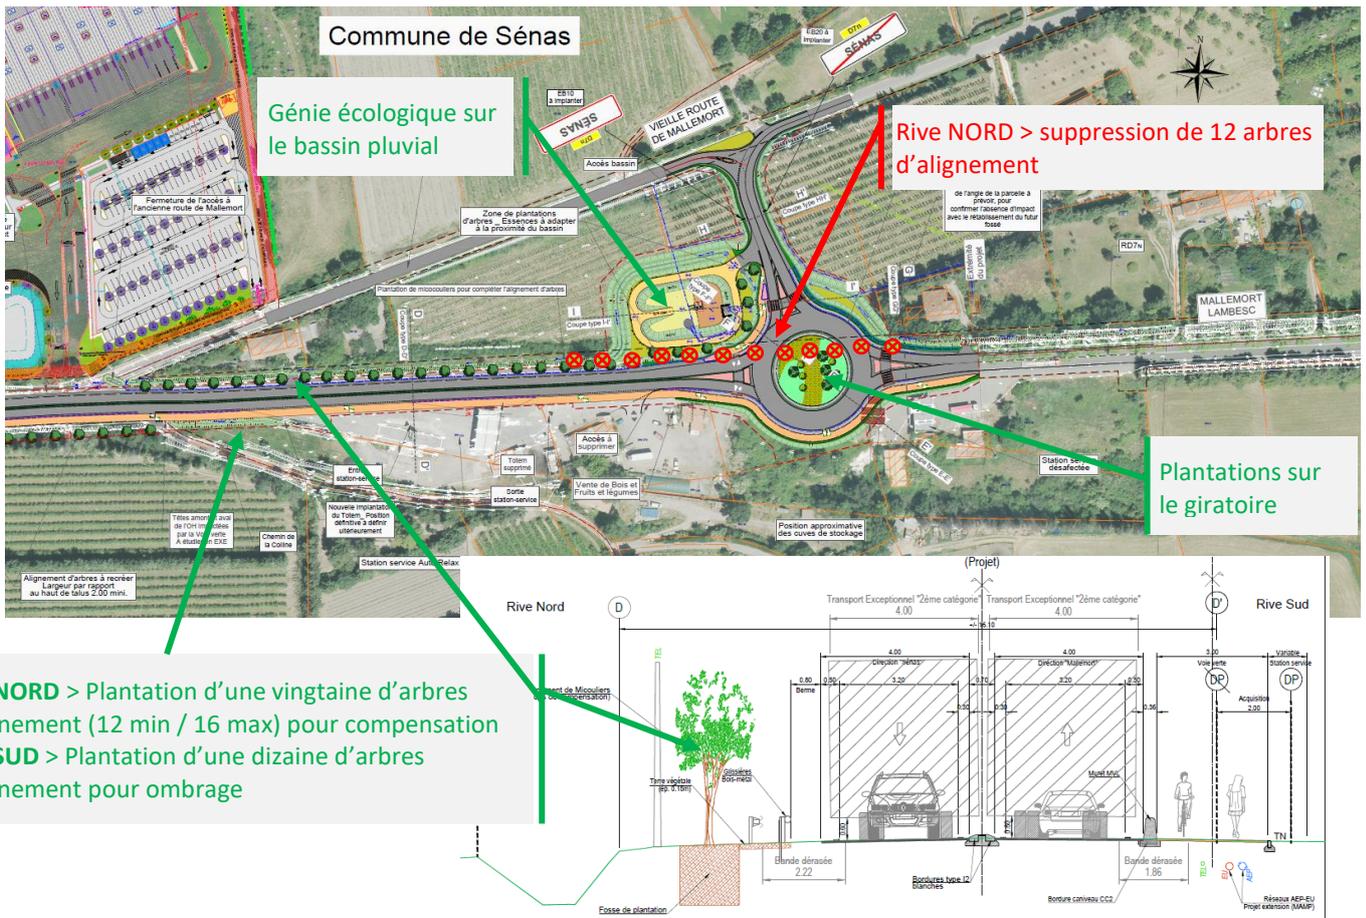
PLAN D'AMENAGEMENT - PLANCHE 3/3
